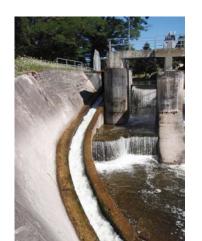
& 19 : de gauche à droite, radier aval, poutre cintrée, piles du barrage et passerelle
